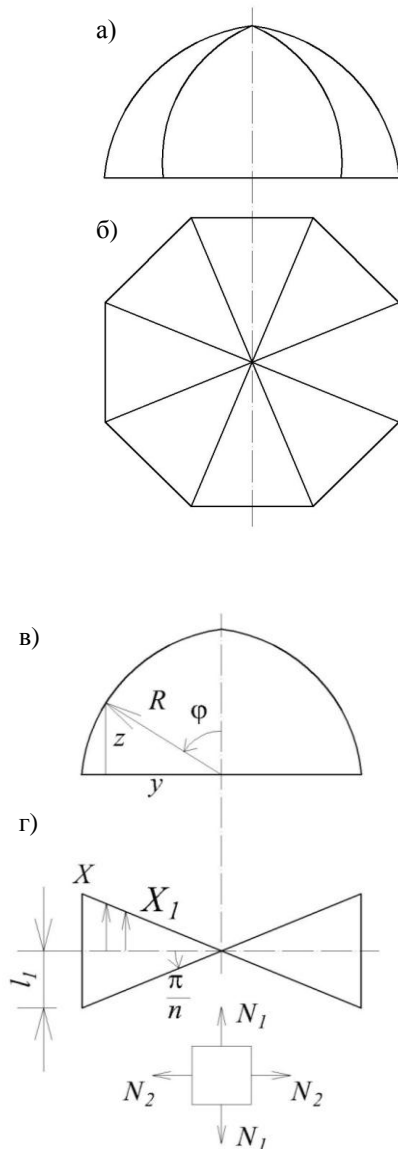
Зімкнуте склепіння: а – фасад; б – план; в – розріз; г – схема зусиль
